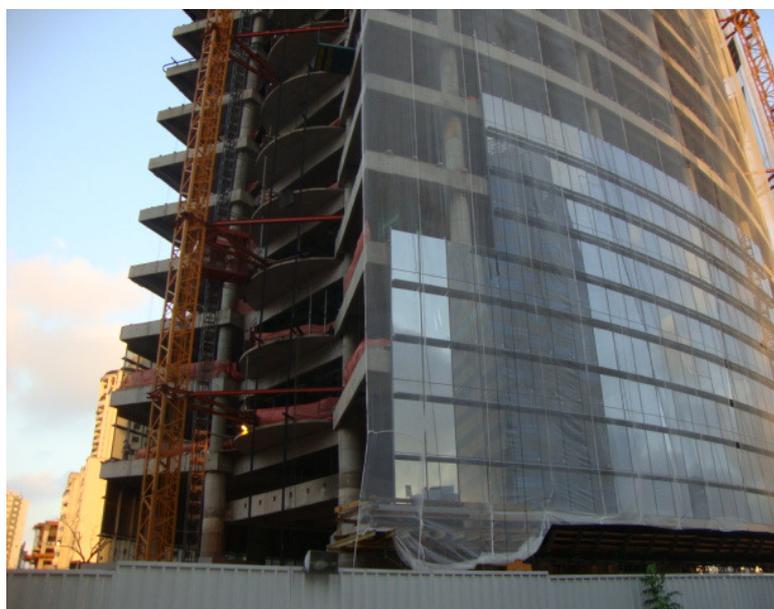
Vista da fachada com aproximadamente 1/4 dos módulos instalados
